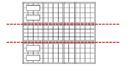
(c) Denah Pembalokan Lantai 1
